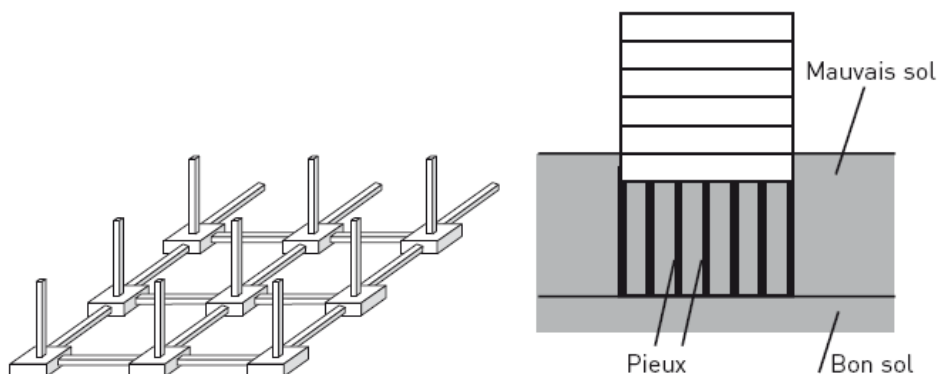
Fondations, à gauche : fondations superficielles, à droite : fondations profondes.
